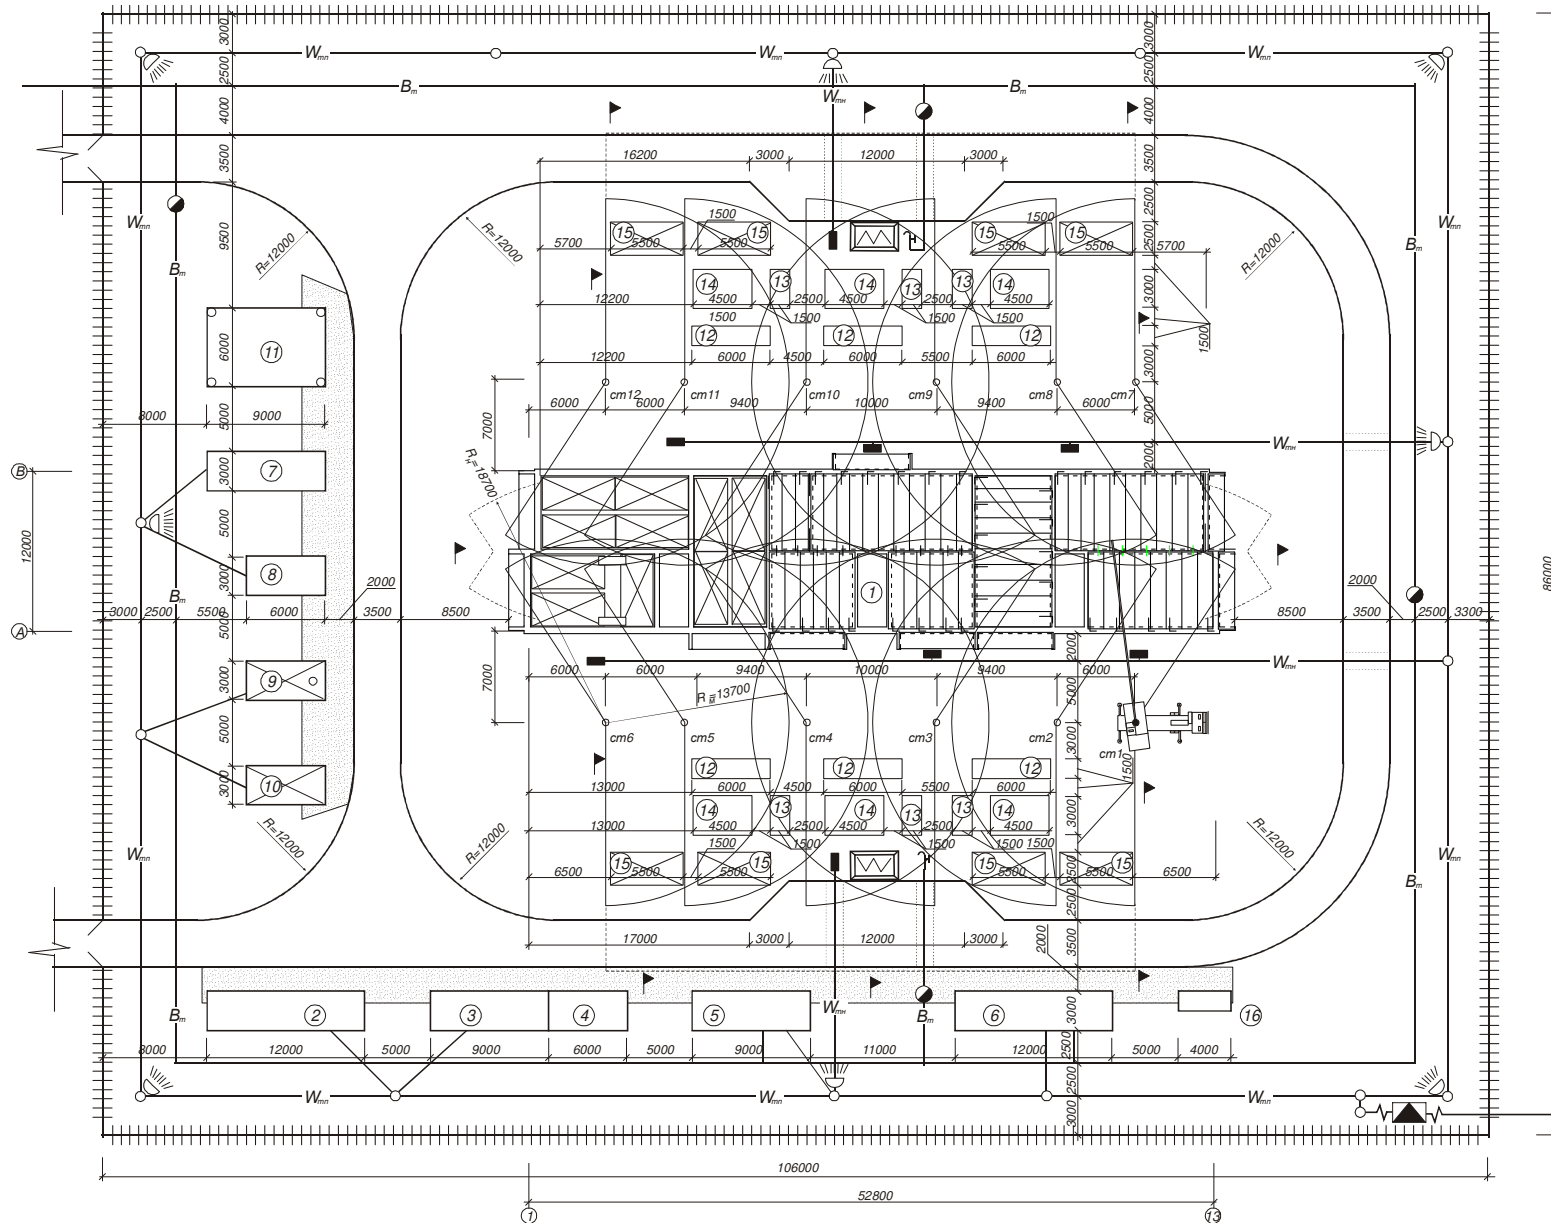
Будівельний генеральний план будівництва житлового двоповерхового будинку
